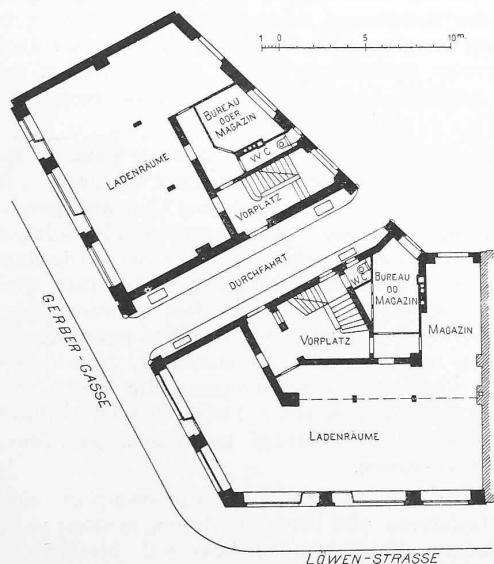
Grundriss vom Erdgeschoss.
